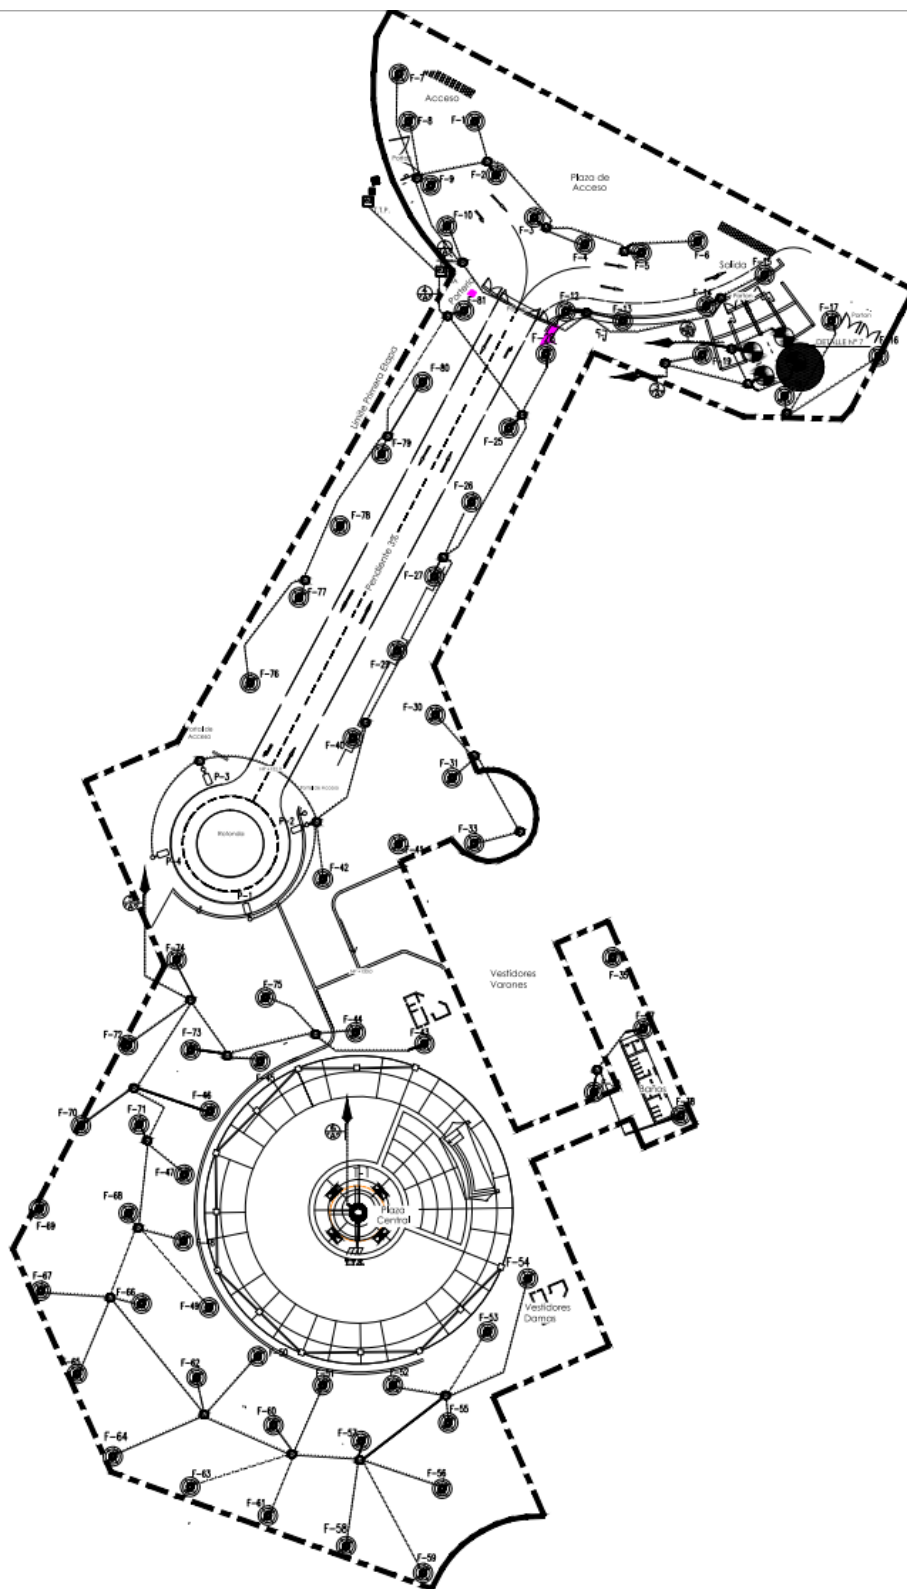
PLANO DE ILUMINACIÓN EXTERIOR DEL PARQUE.
